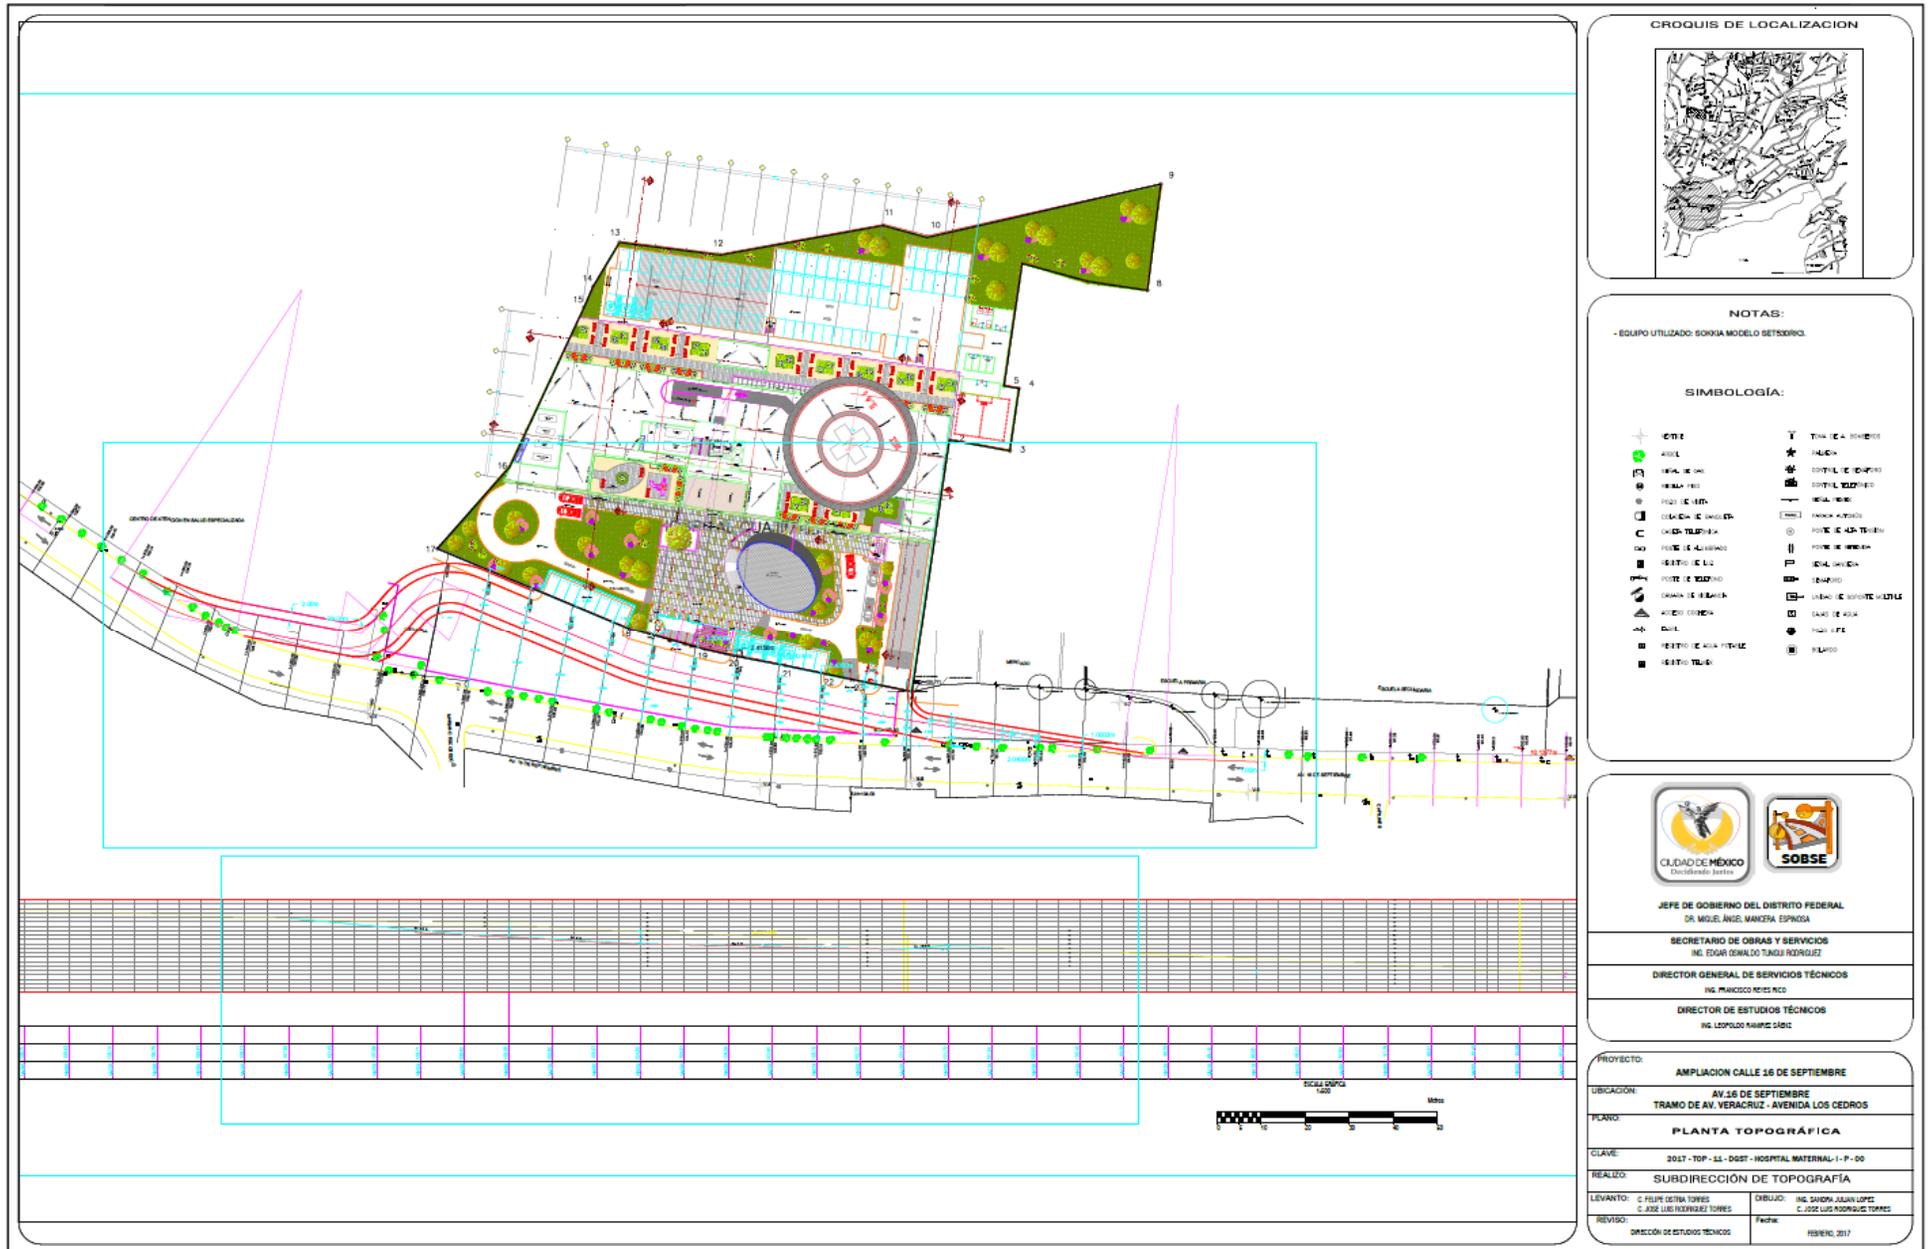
Plano Topográfico, Eje de proyecto y Perfil longitudinal.
